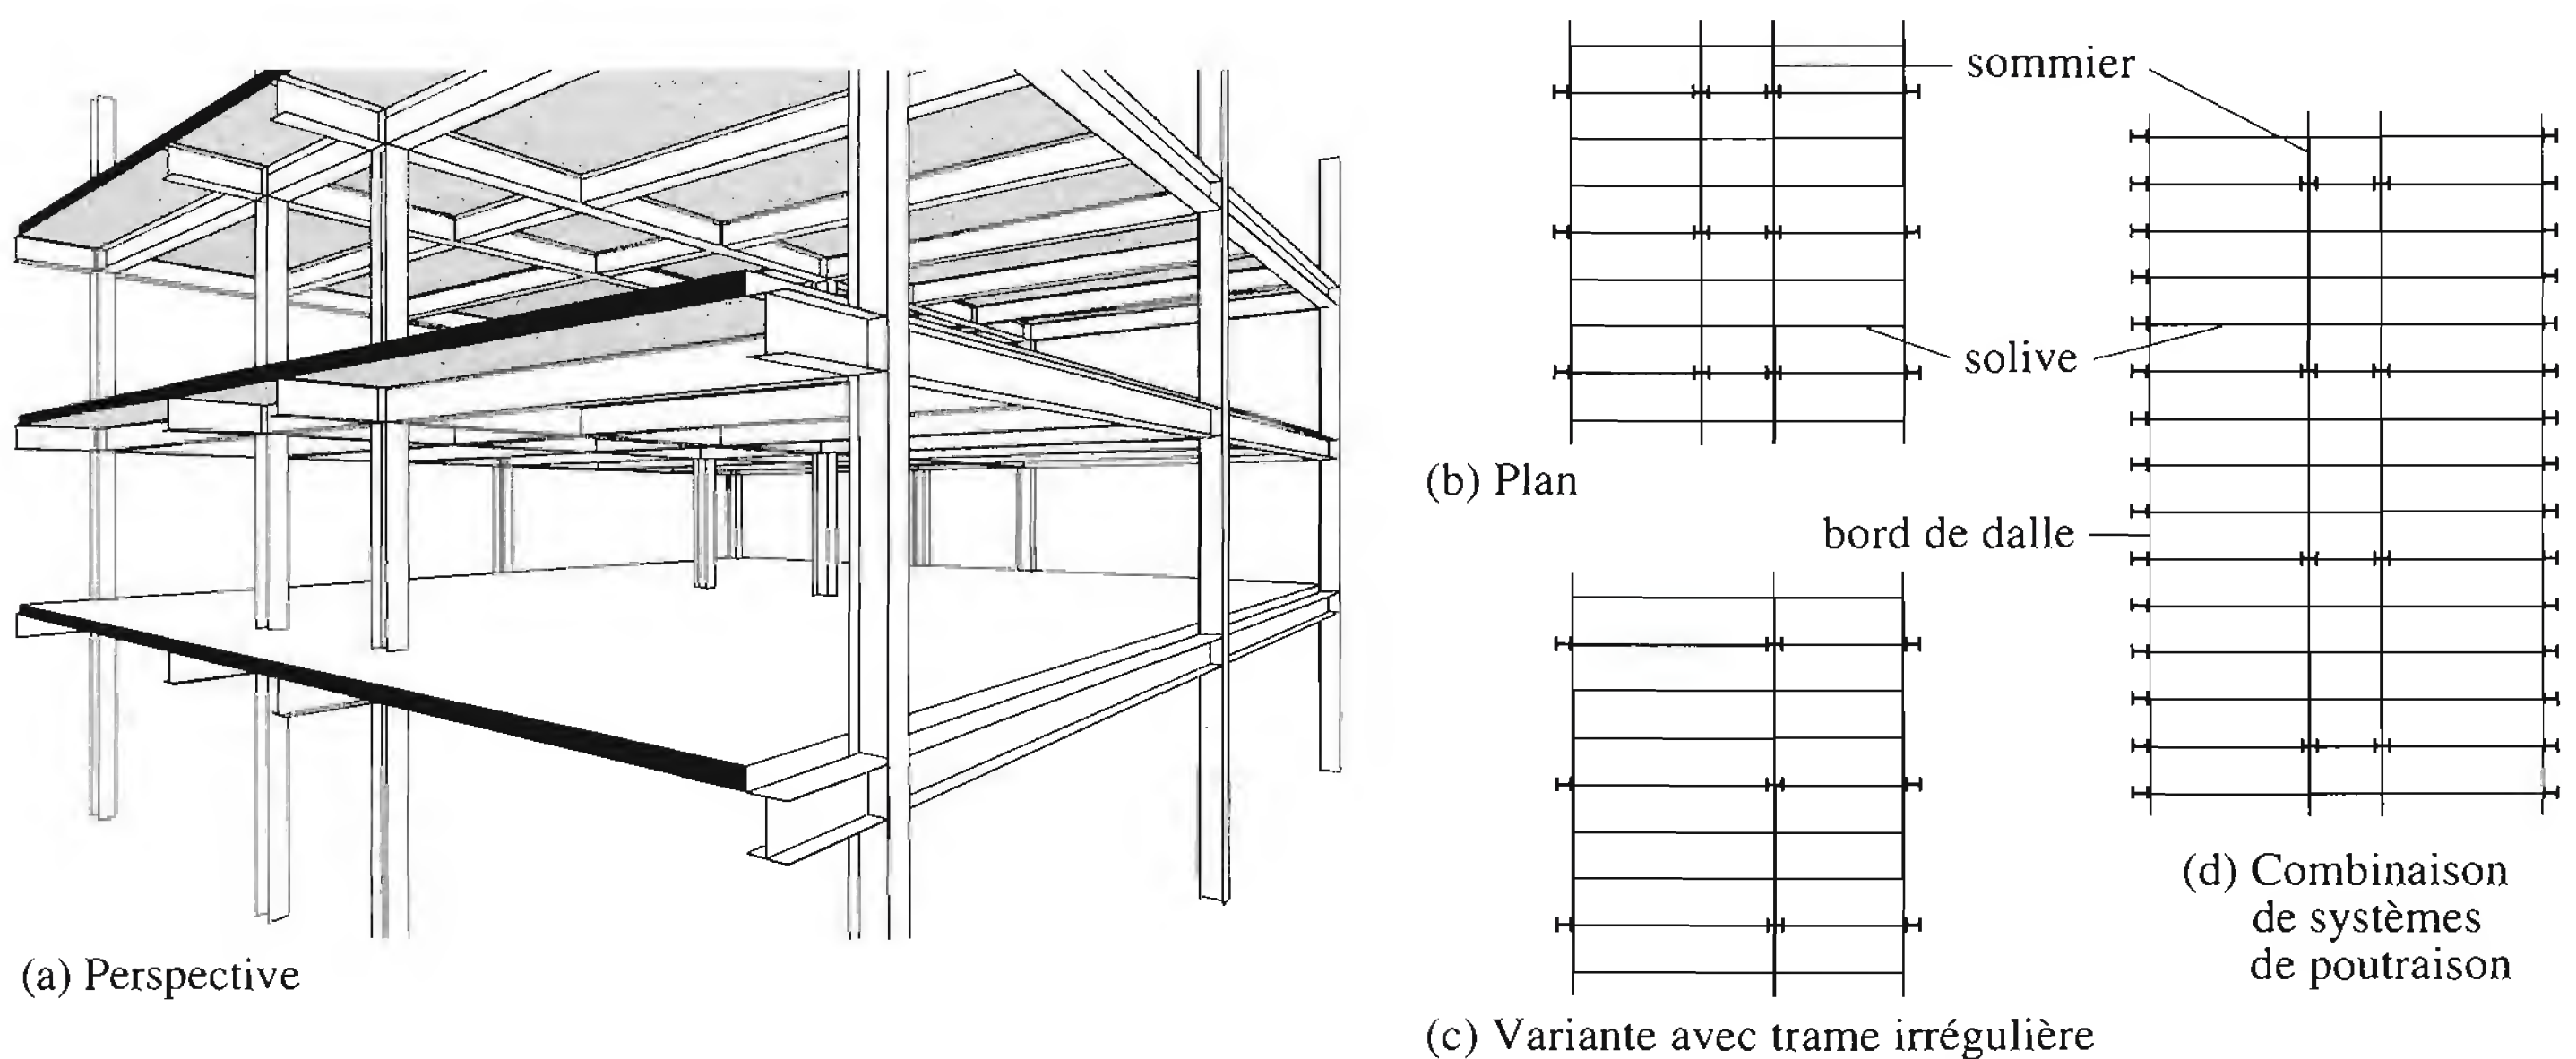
Planchers à deux niveaux de poutres (tiré de [4.1]).
